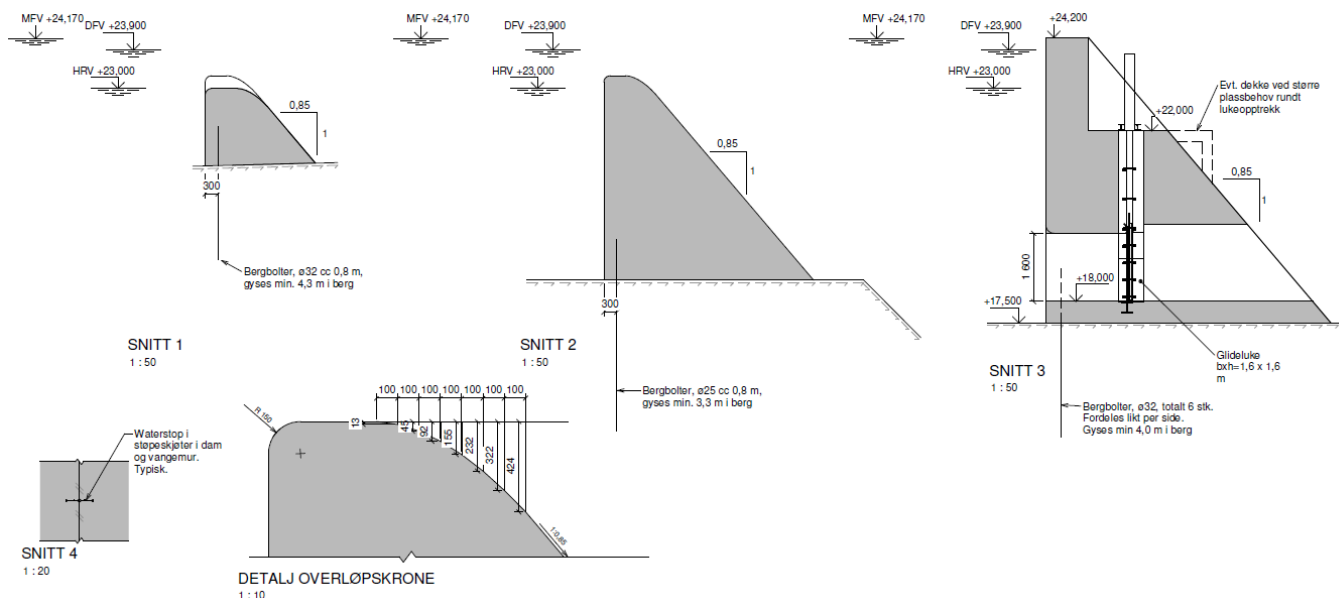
Tverrsnitt av planlagt fyllingsdam.
